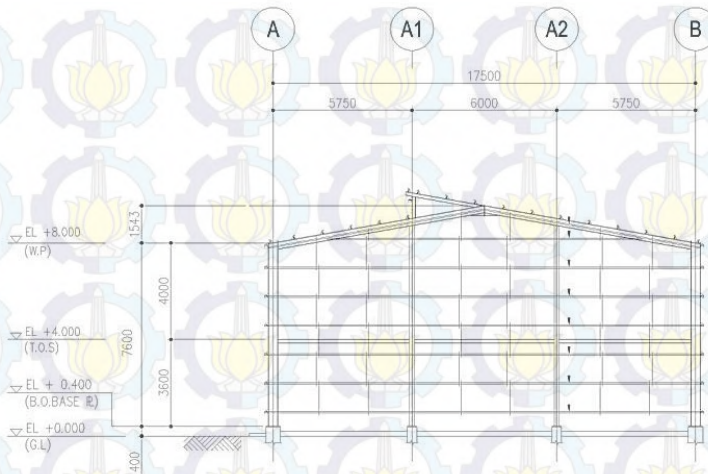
Denah Struktur Sistem *Pre-Engineering Building
